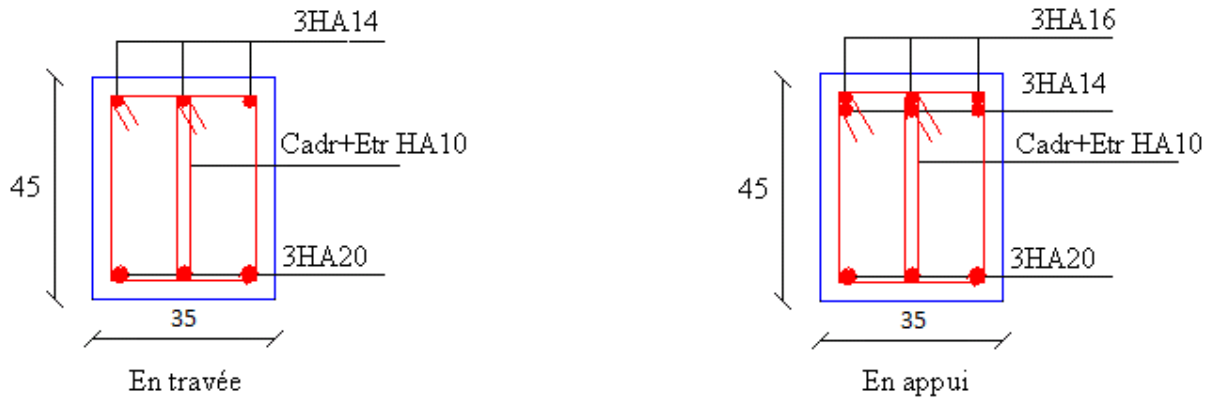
Schéma du ferrailage des poutres principales d'étage courant
